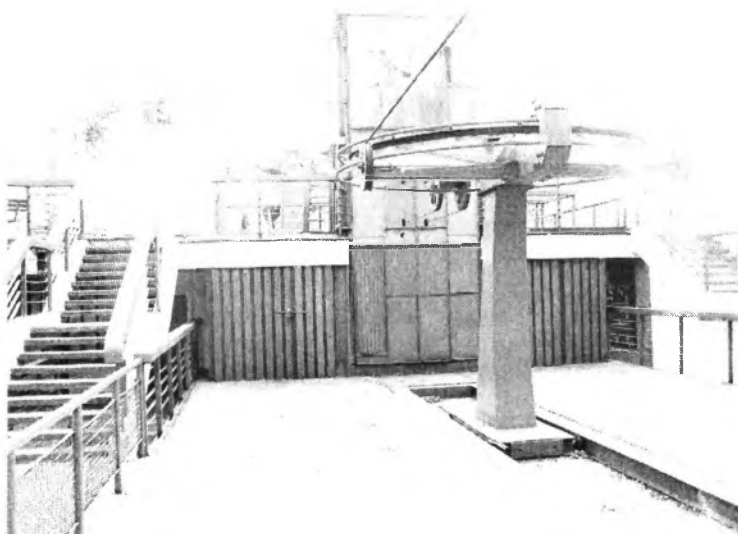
Widok baterii krążków – konstrukcja zastosowana w kolei ELKA
